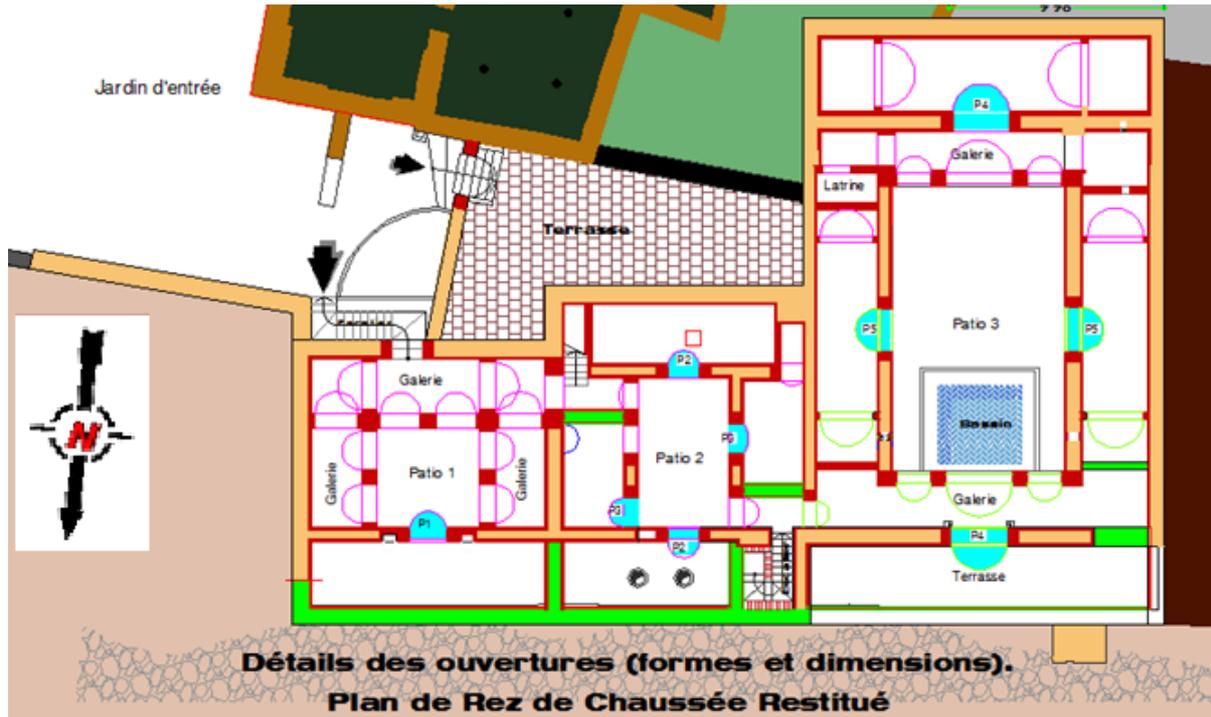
Détails des ouvertures (formes et dimensions) sur plan de Rez de Chaussée. Source : Auteur 2015
